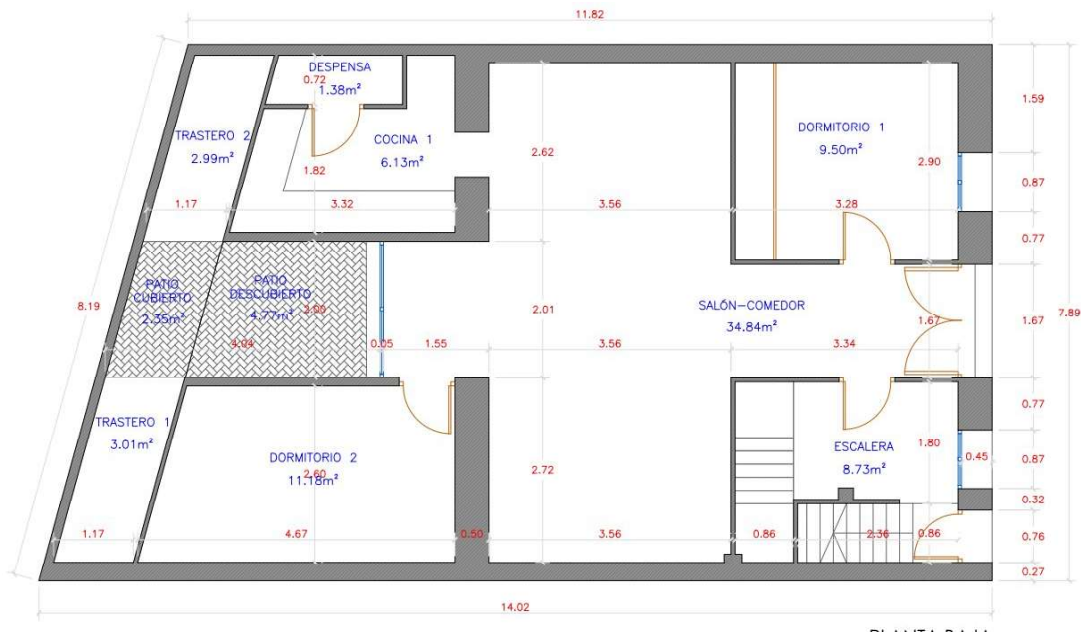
Estado inicial de la planta baja (proyecto básico)
